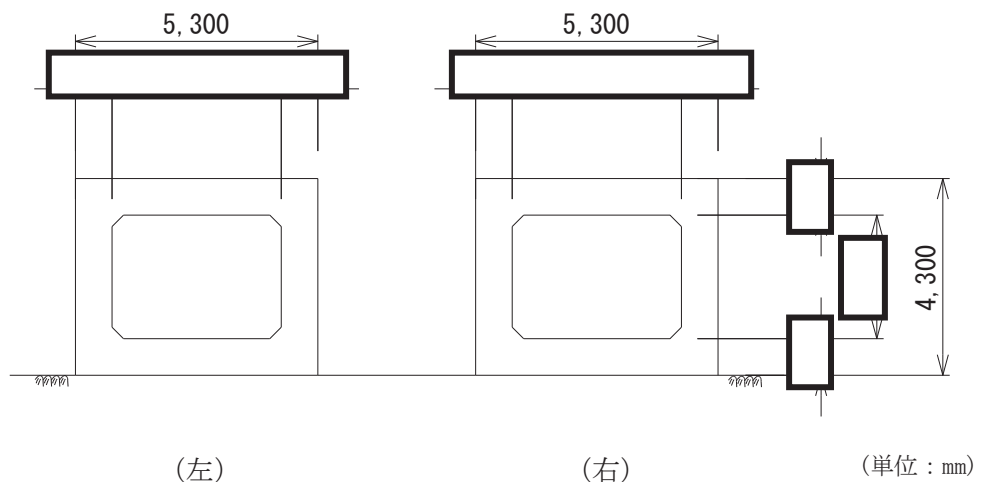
(2) 第1号機取水路の断面図 (B-B断面)
